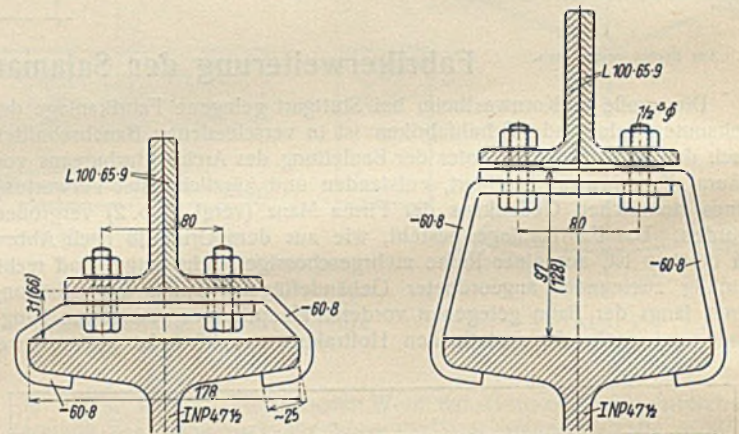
Klammernbefestigung der neuen Fußbodenkonstruktion.
